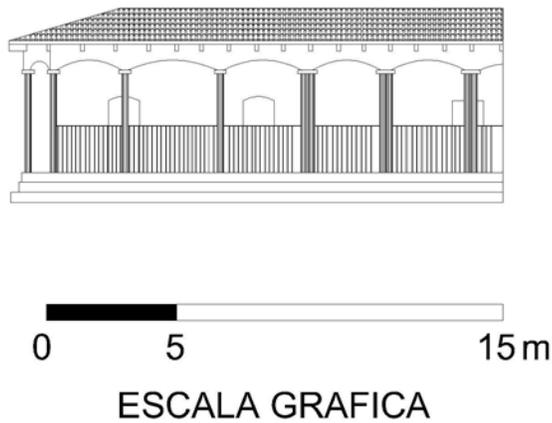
Fachada principal. Casa de la Cultura. Elaboró: Mauricio
